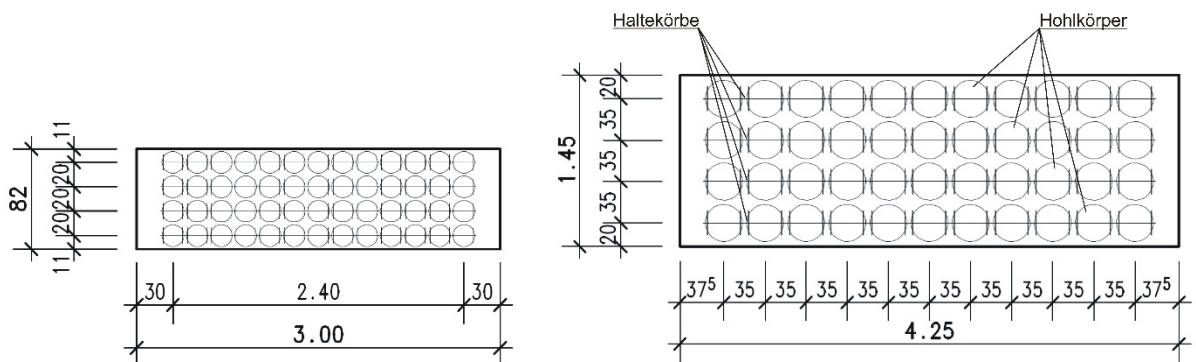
Grundriss der Versuchskörper der ersten (links) und zweiten (rechts) Versuchsserie mit angezeichneten Haltekörben
